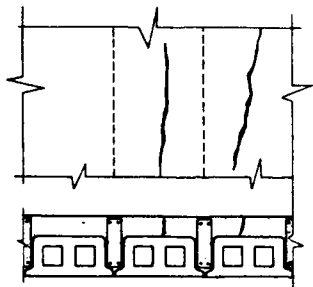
Agrietamiento por contracción de secado del hormigón fresco de una losa cerámica.
